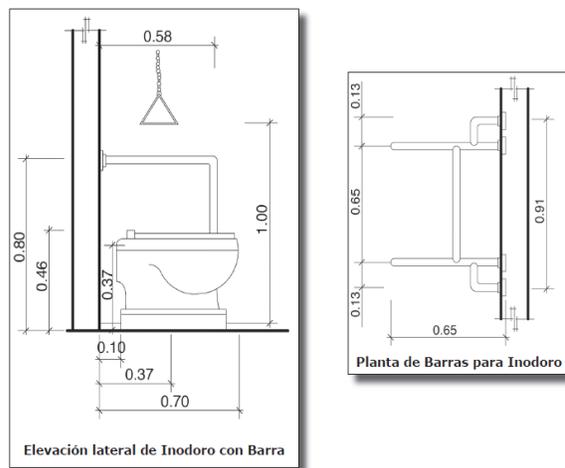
Elevación y planta de barras para inodoro, CONADI, 106.
